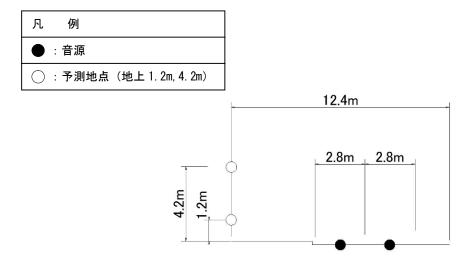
(4) 予測断面図(D.村道 16 号線沿道(宮田村 6747-5 地先))
